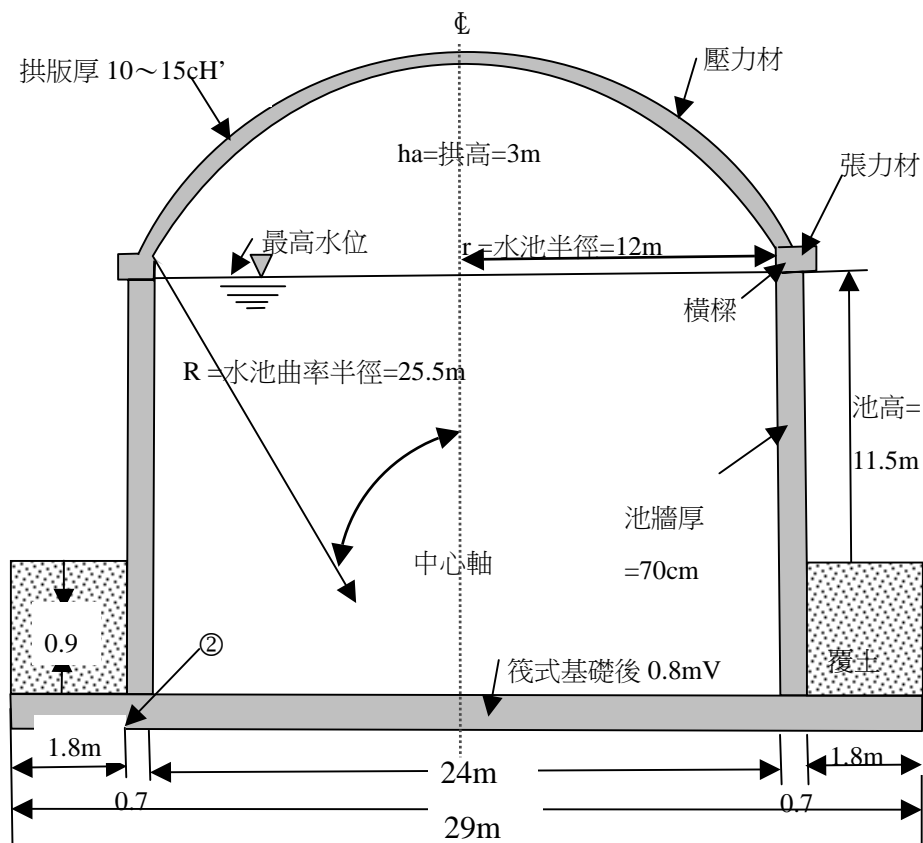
無預力鋼筋混凝土球面拱頂圓形水池斷面示意
